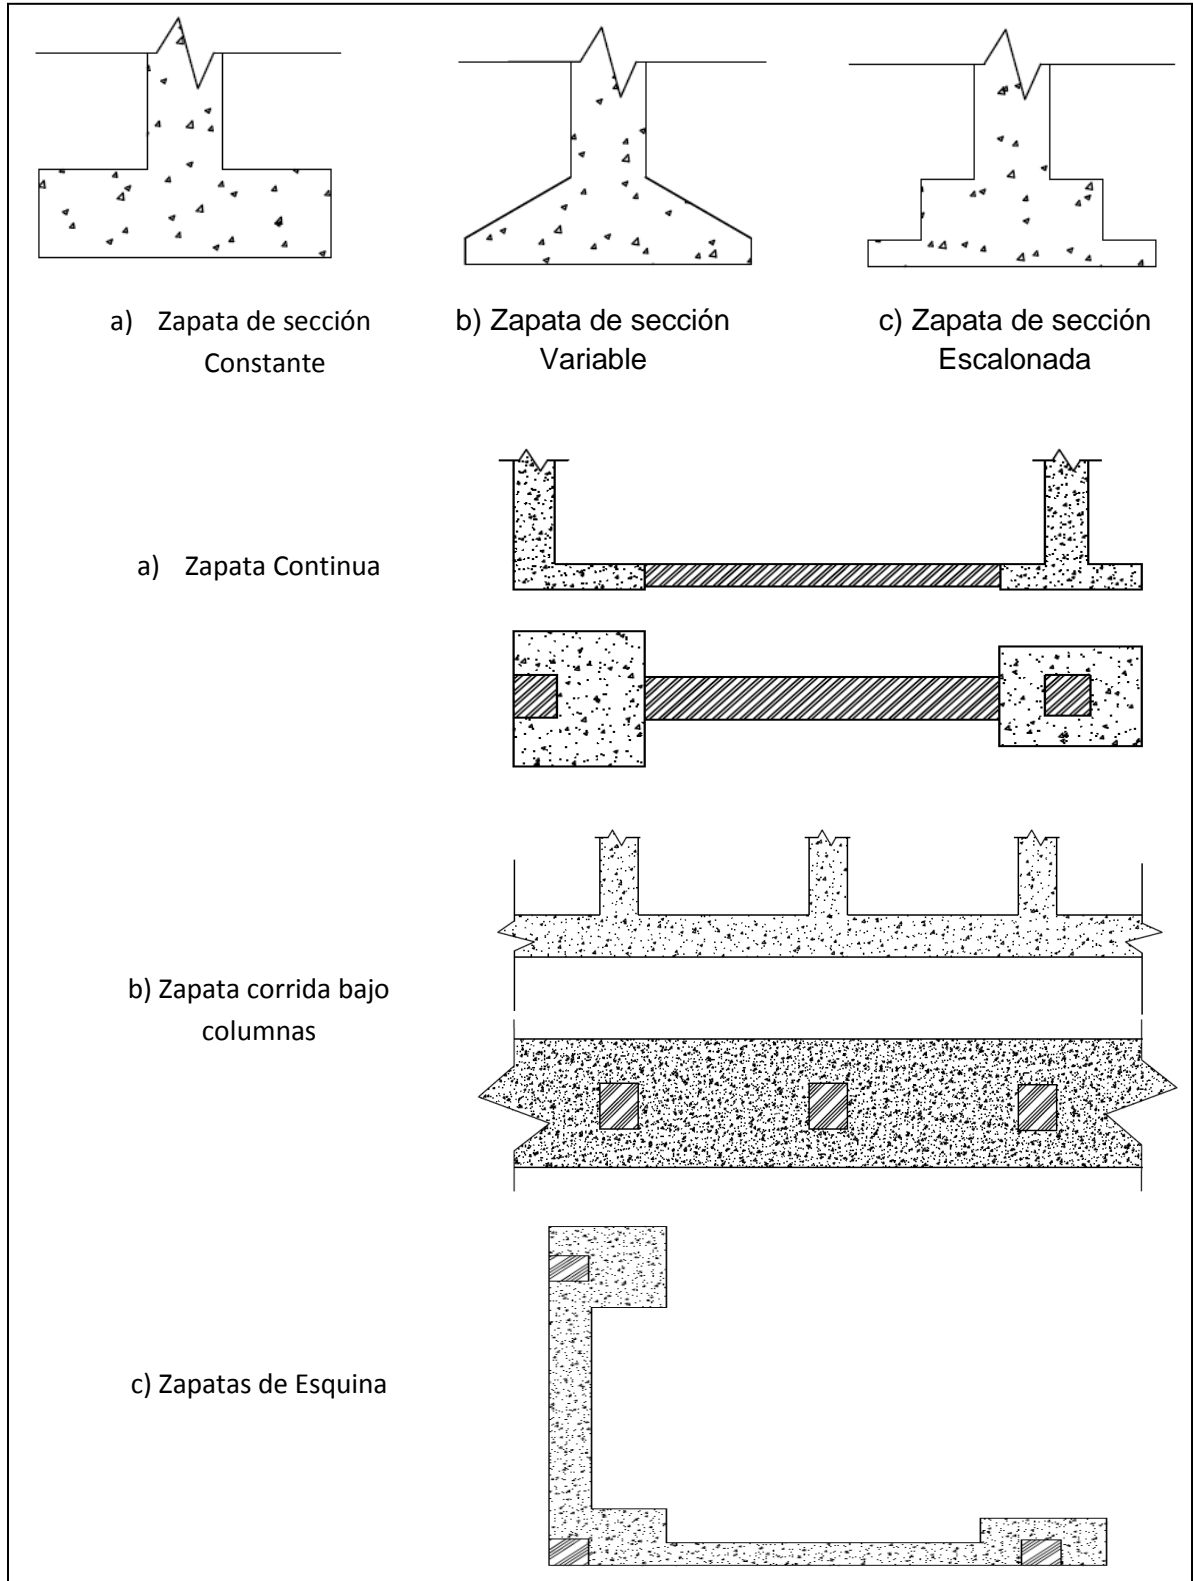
Formas Típicas acomodados convencionales de las Zapatas aisladas y corridas de Concreto Reforzado
